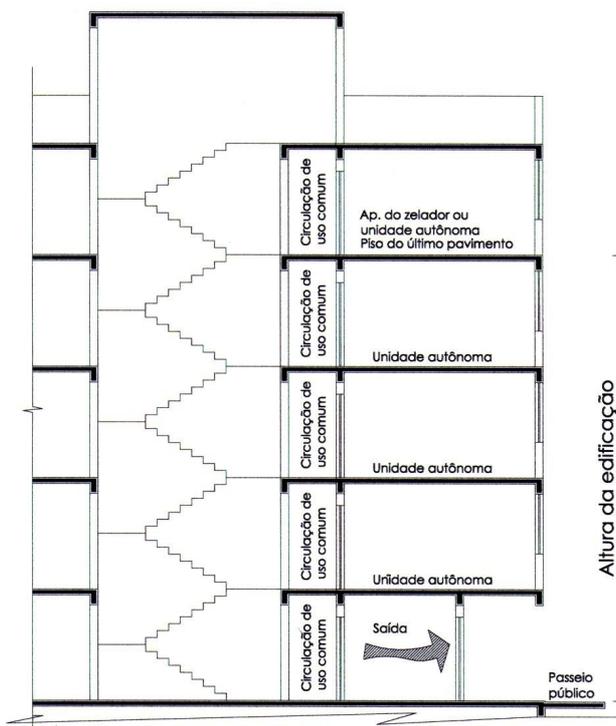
Último pavimento constituído pelo apartamento do zelador.
